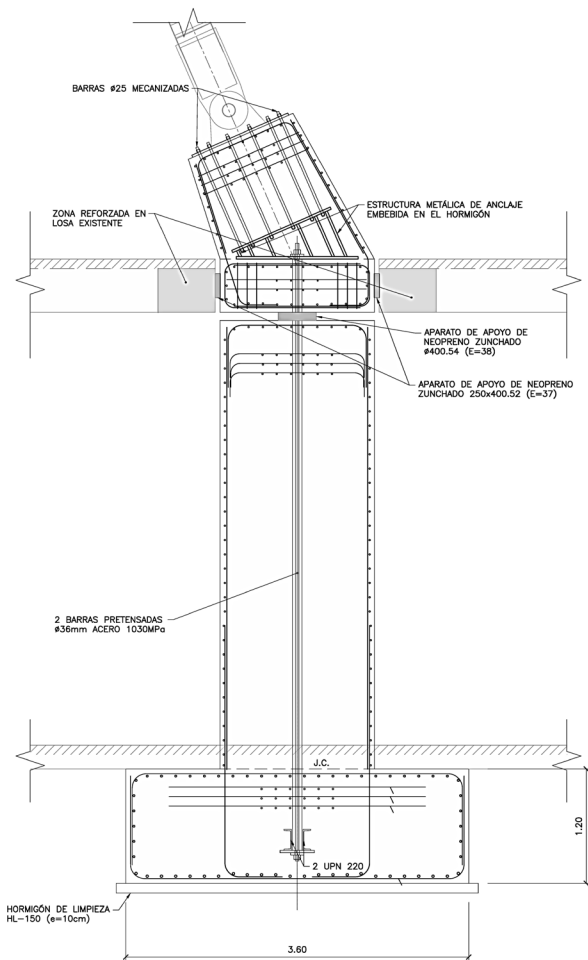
Sección de sistema de apoyo a través de forjado y planta de aparcamiento.
